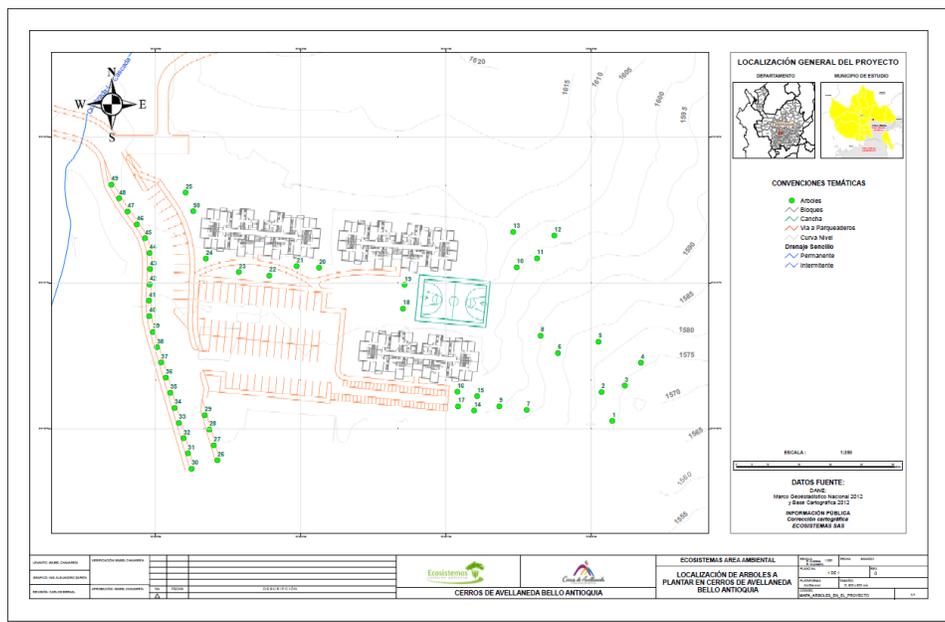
Plano de ubicación de la propuesta de reposición al interior del predio
